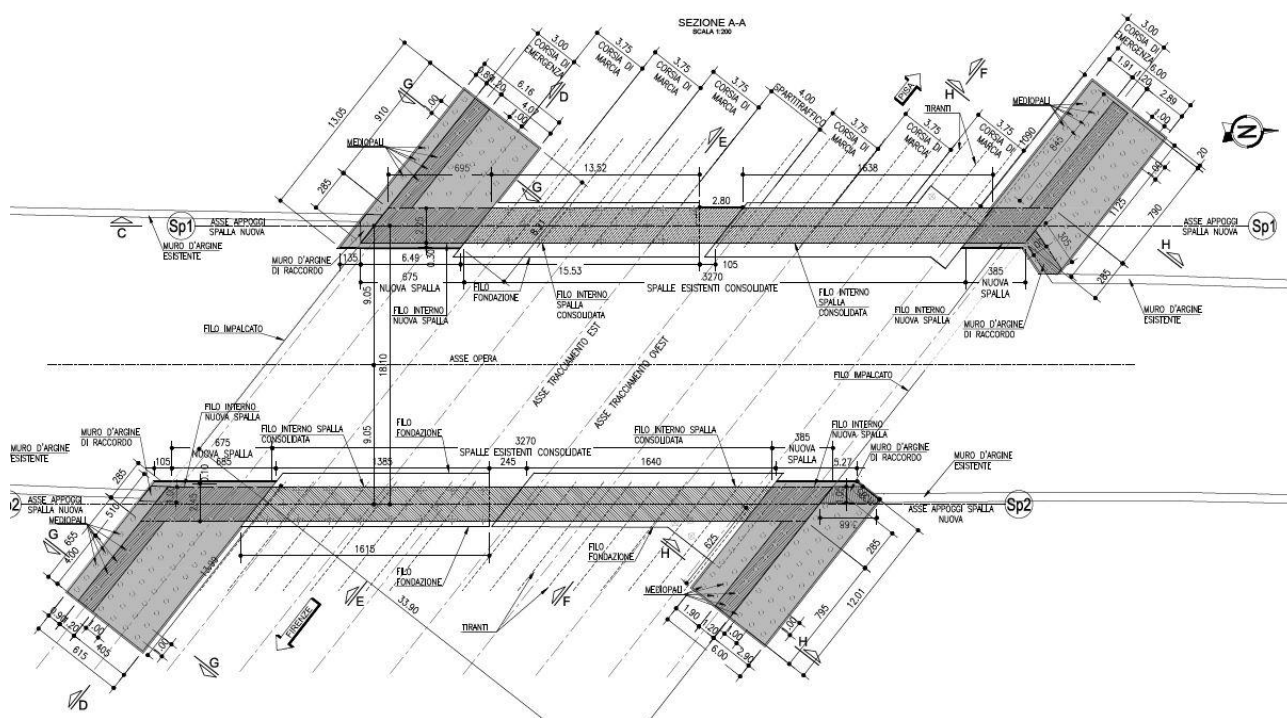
Planimetria di progetto opere di fondazione.
